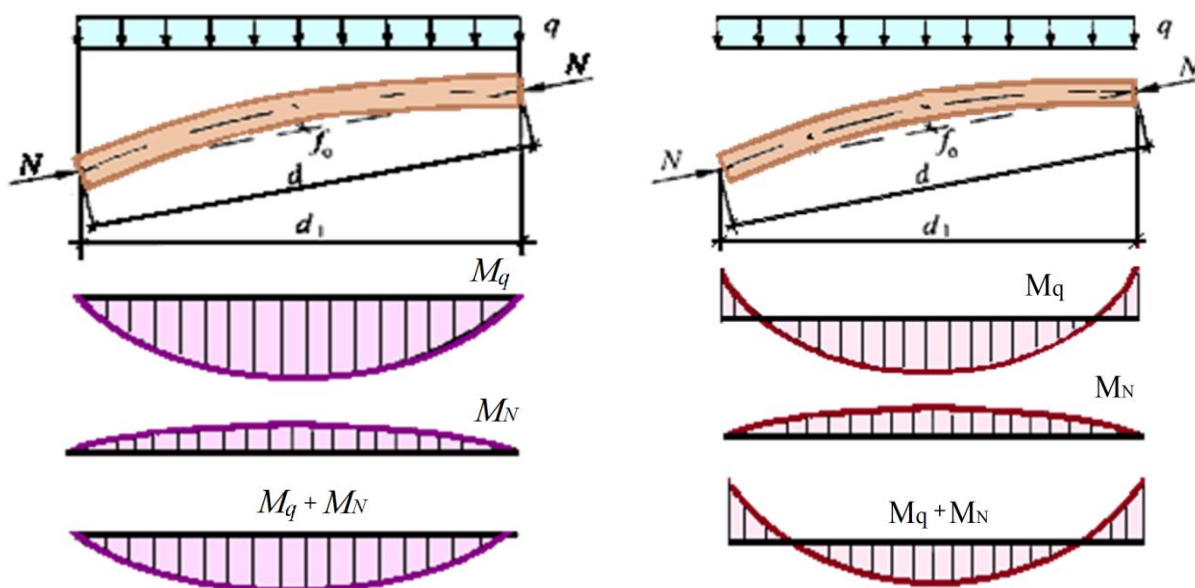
Расчетная схема рядовой панели верхнего пояса сегментной фермы с разрезным и неразрезным верхним поясом
